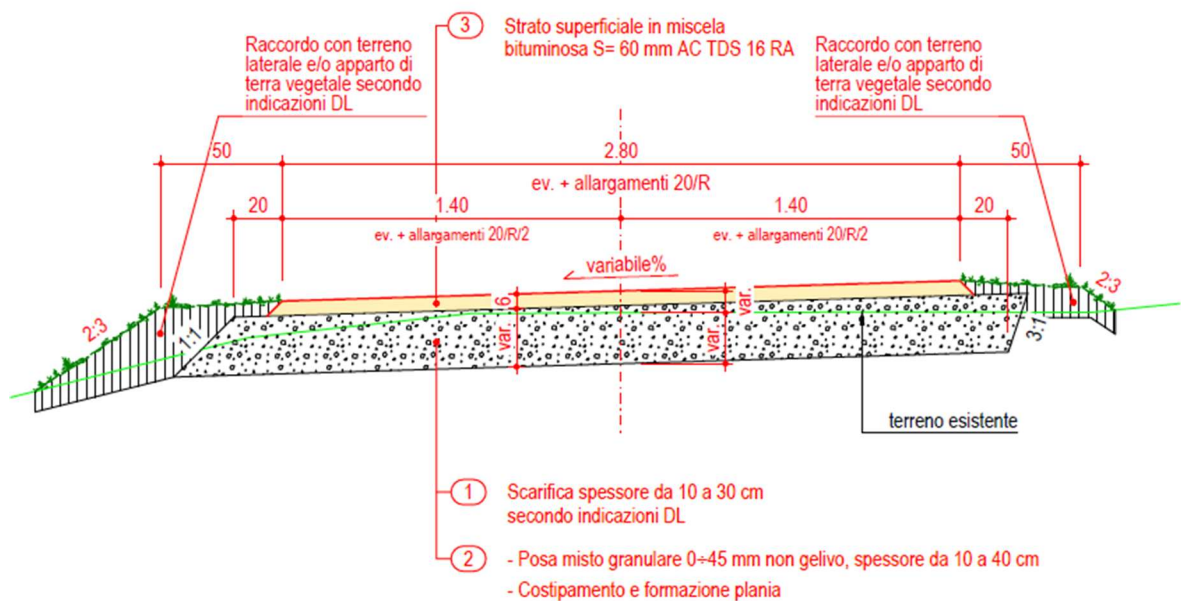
Sezione tipo scarifica e nuova pavimentazione in asfalto
